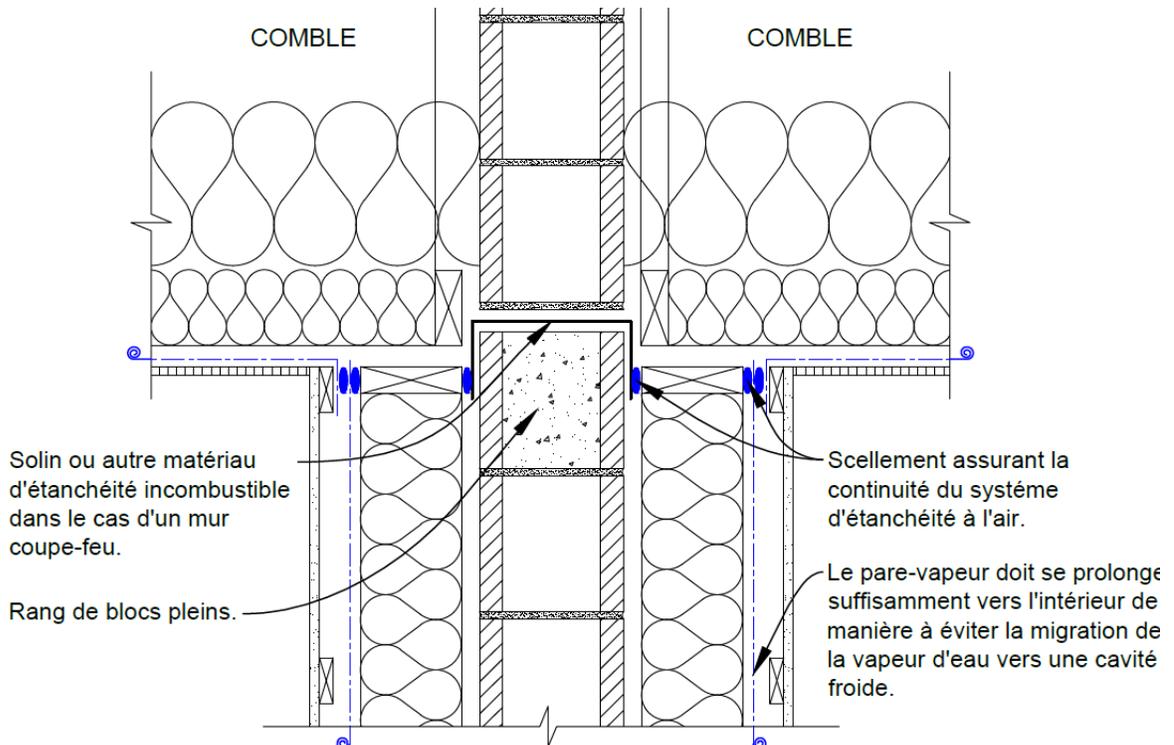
Étanchéité d'un mur mitoyen – Recouvrement complet de toutes les surfaces intérieures (art.2.2.2.6b)ii))
